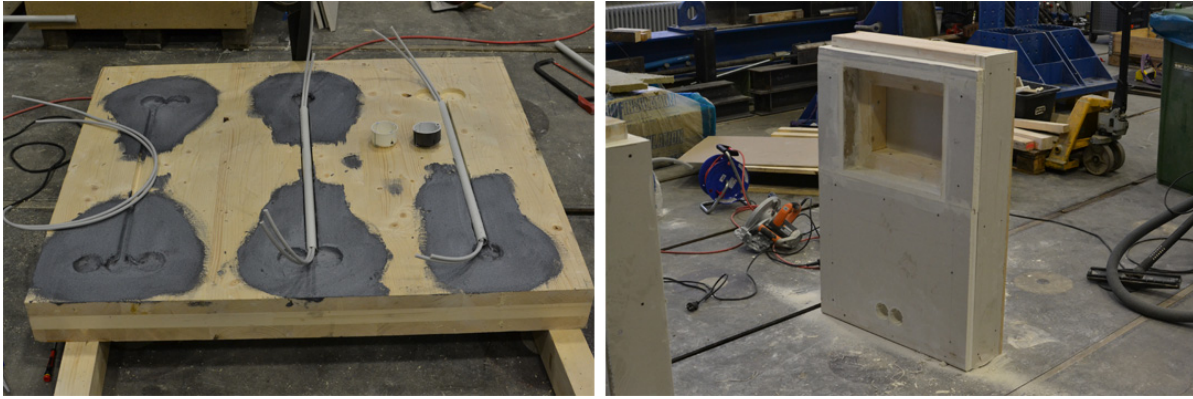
V4: links das Wandelement aus Brettsperrholz mit Brandschutzanstrich und Elektroinstallationen, rechts das Holzständerwandelement mit dem eingebauten Holzrahmen
